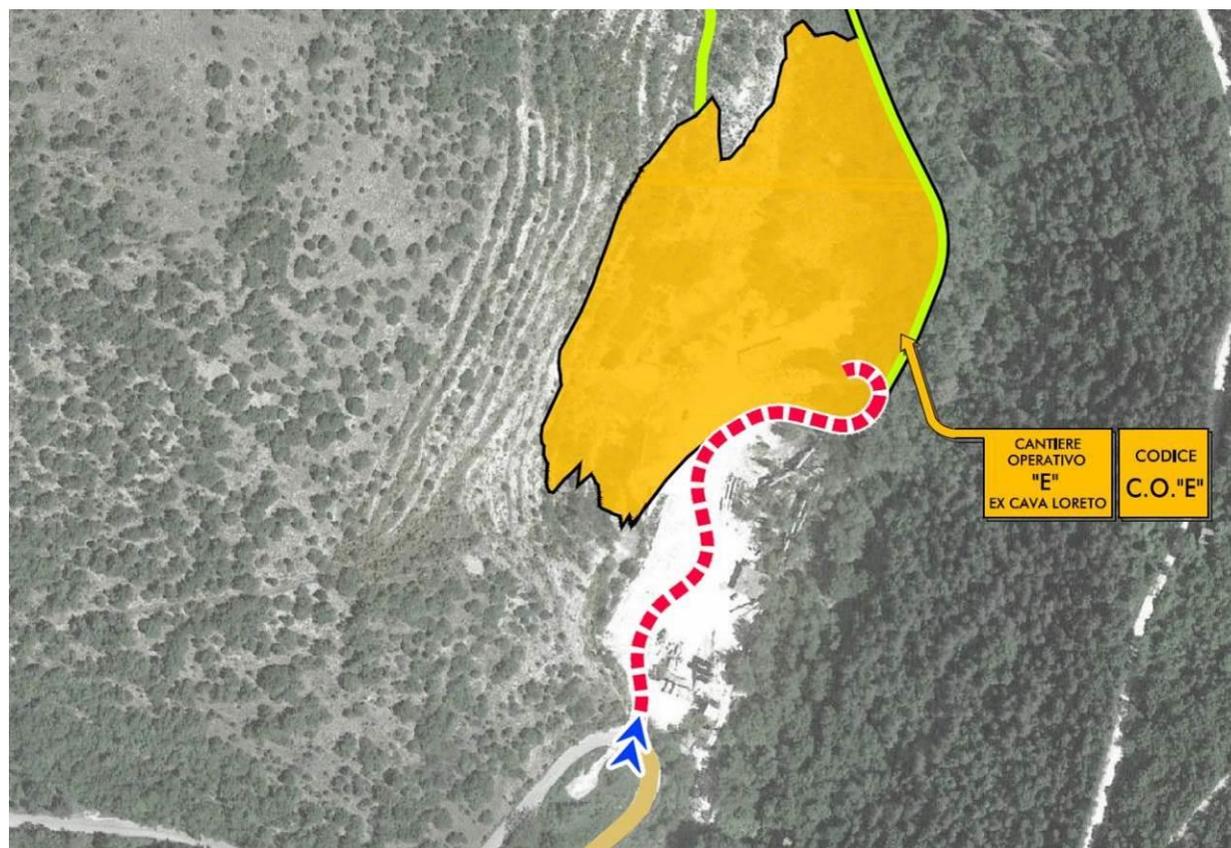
PISTA DI CANTIERE PER IL COLLEGAMENTO ALL'IMBOCCO "MOLINELLO" EST
